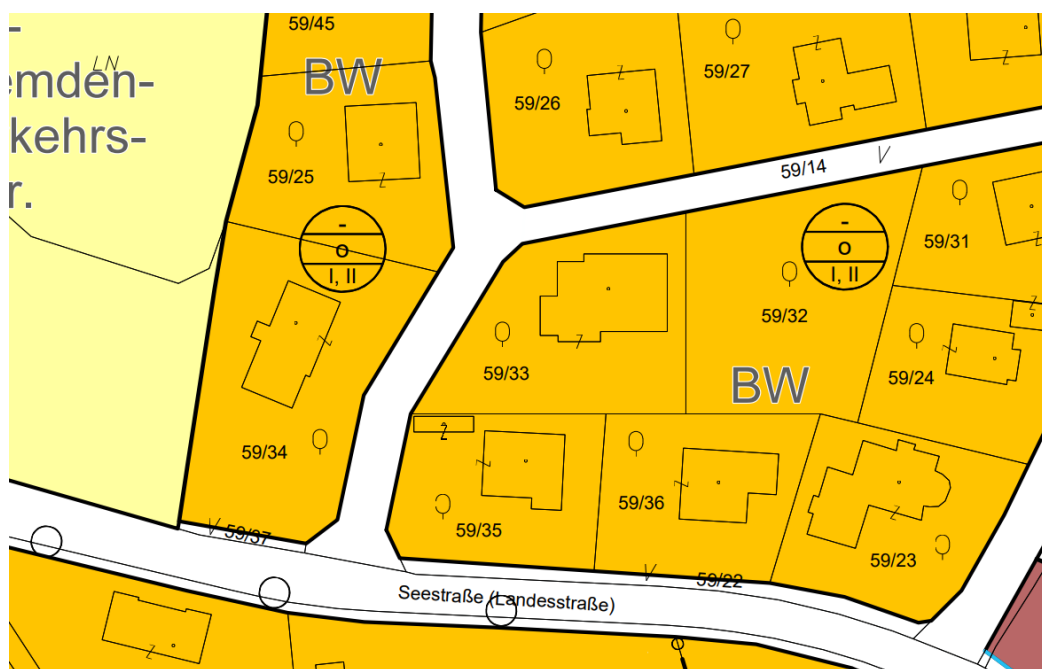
Ausschnitt aus Bebauungsplan Entwurf
